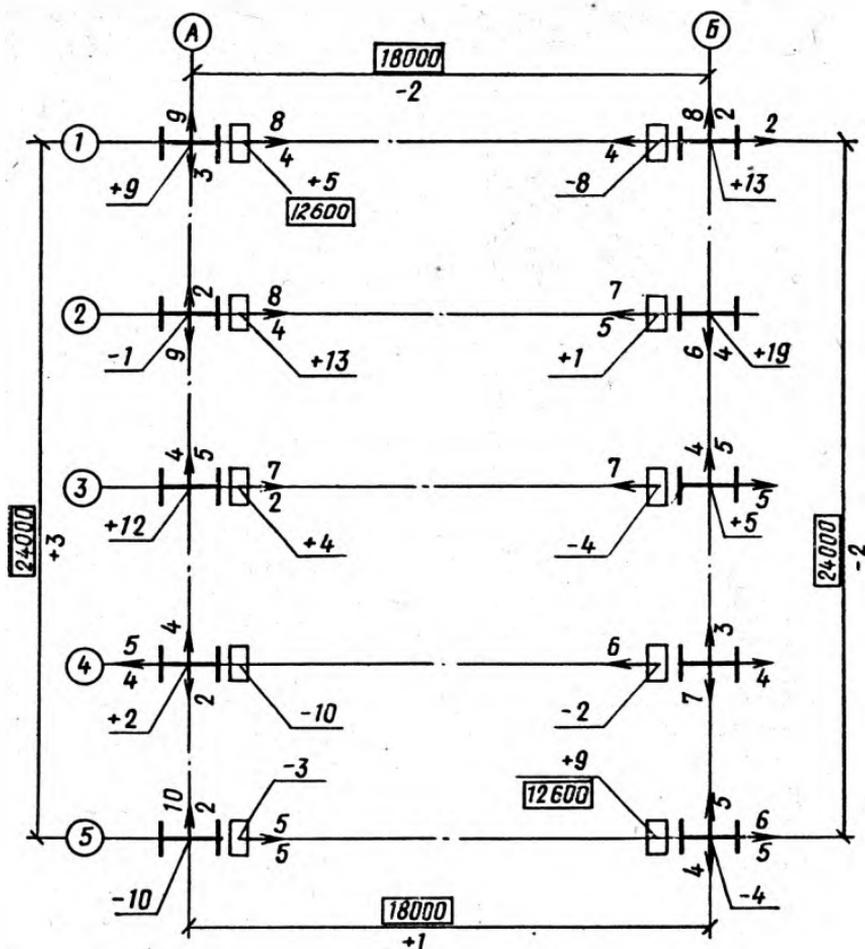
Исполнительная схема положения колонн (цифры у выносных линий показывают отклонения отметки подкрановой ступени и верха колонны, цифры в рамках — проектные отметки; стрелками обозначены направления смещения колонн в верхнем и нижнем сечении, цифры возле них показывают величину смещения: над стрелкой — верха, под стрелкой — низа колонны)
